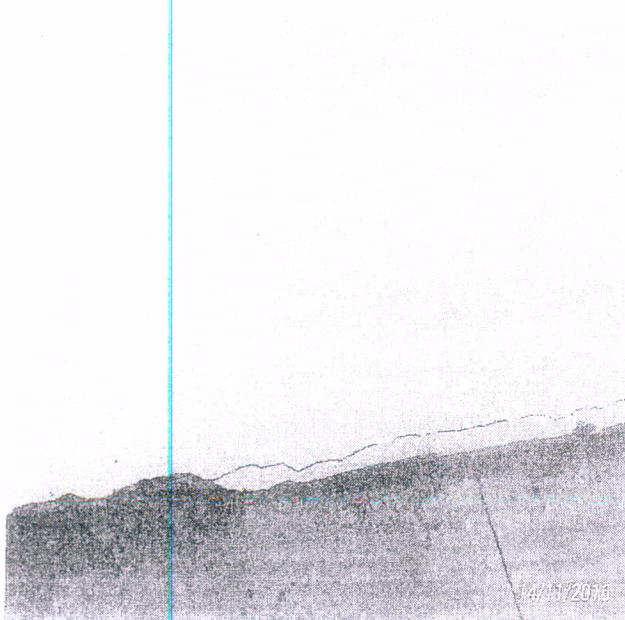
Fissuras na base das alvenarias das paredes externas, devido a umidade ascendente do solo.
